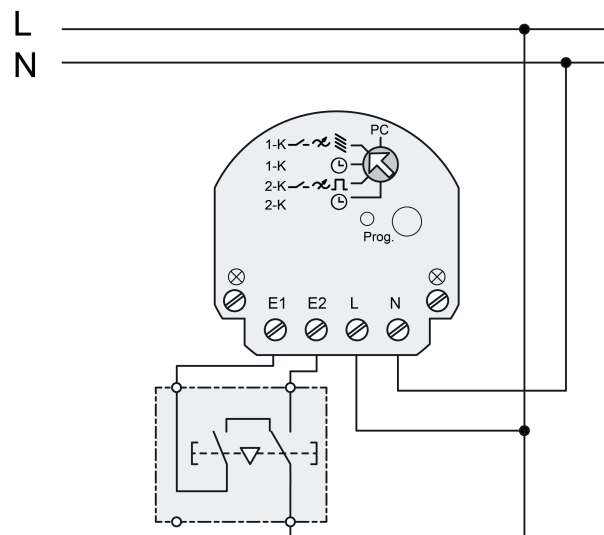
Exemple de raccordement avec bouton-poussoir de store
